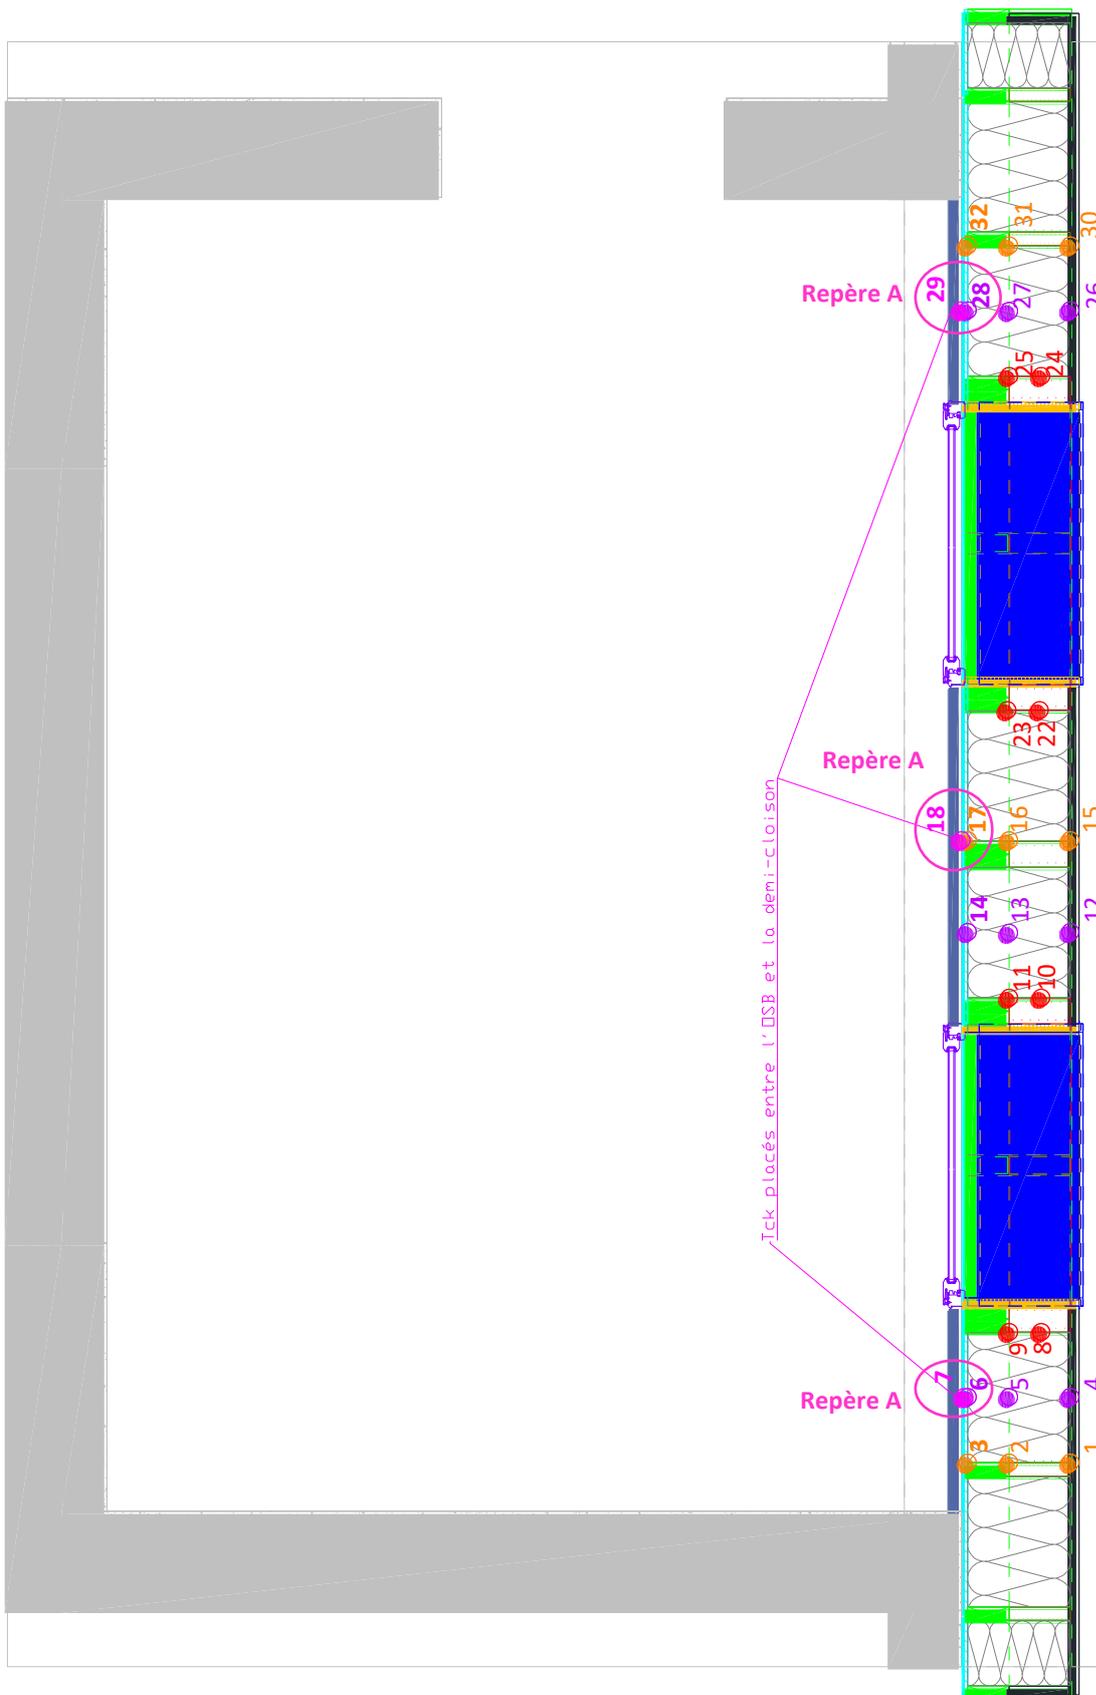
Instrumentation de l'élément de façade - Coupe II-II
